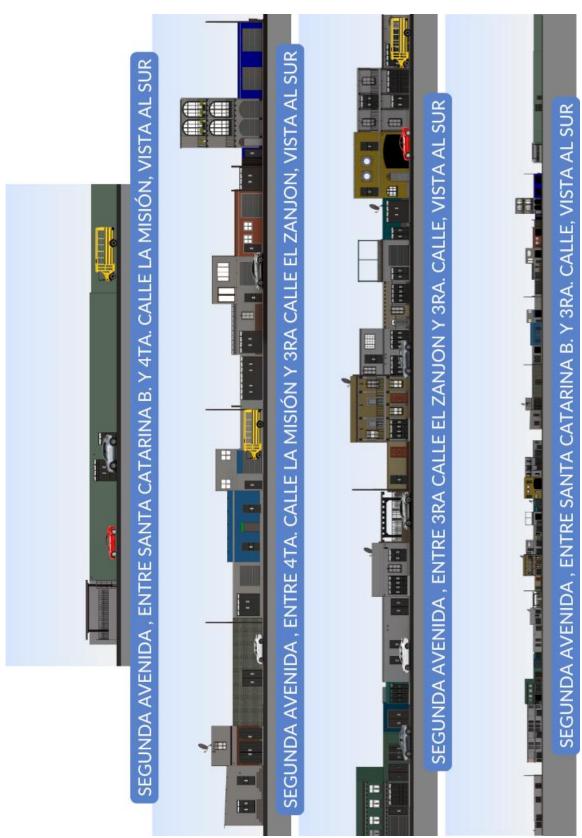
Elevación del estado actual de las fachadas en la Segunda Avenida de San Antonio Aguas Calientes, 2025.
